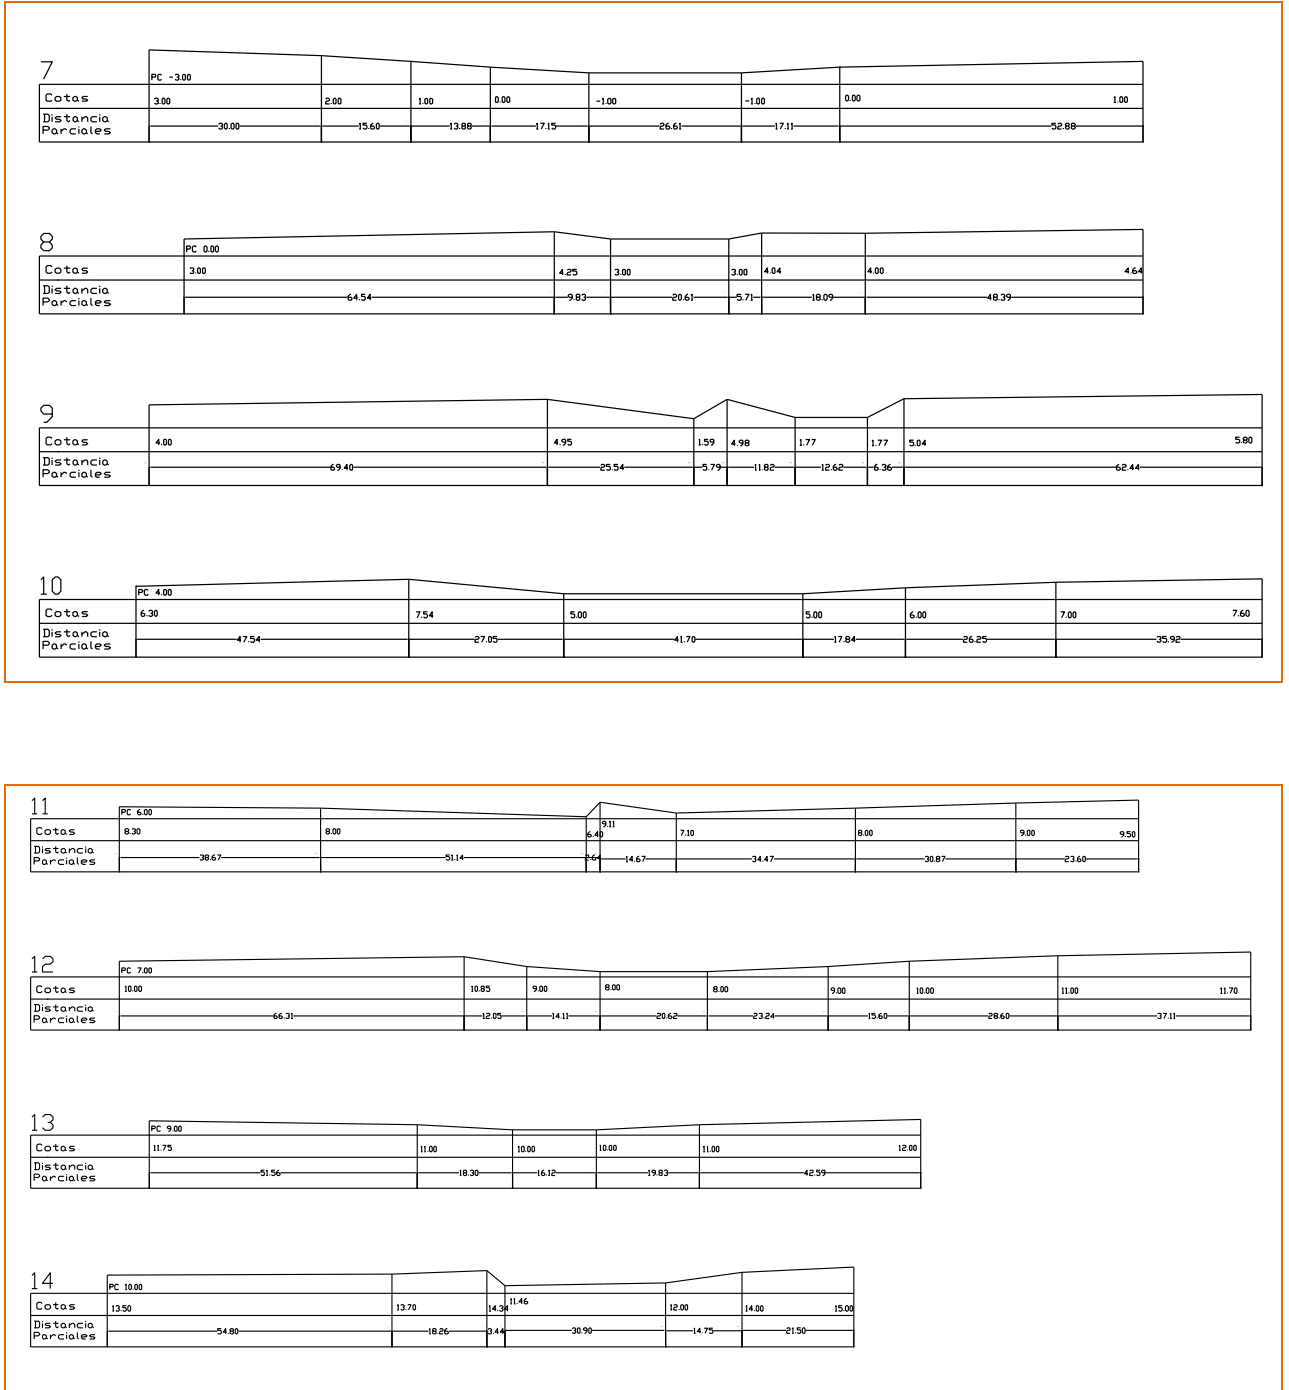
Perfiles Transversales 7 al 14 – Basural Cacheuta
